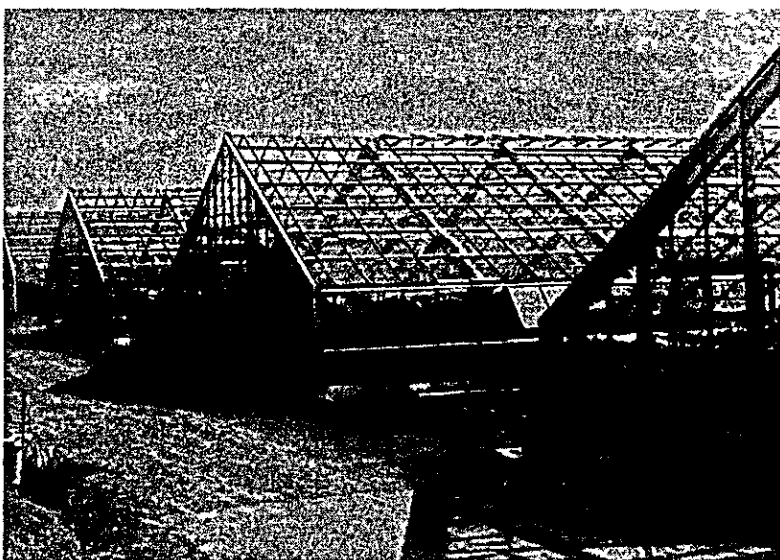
Invernadero de vidrio en forma de techo a dos aguas simétricas y con fachadas de 10 a 15 m de ancho
